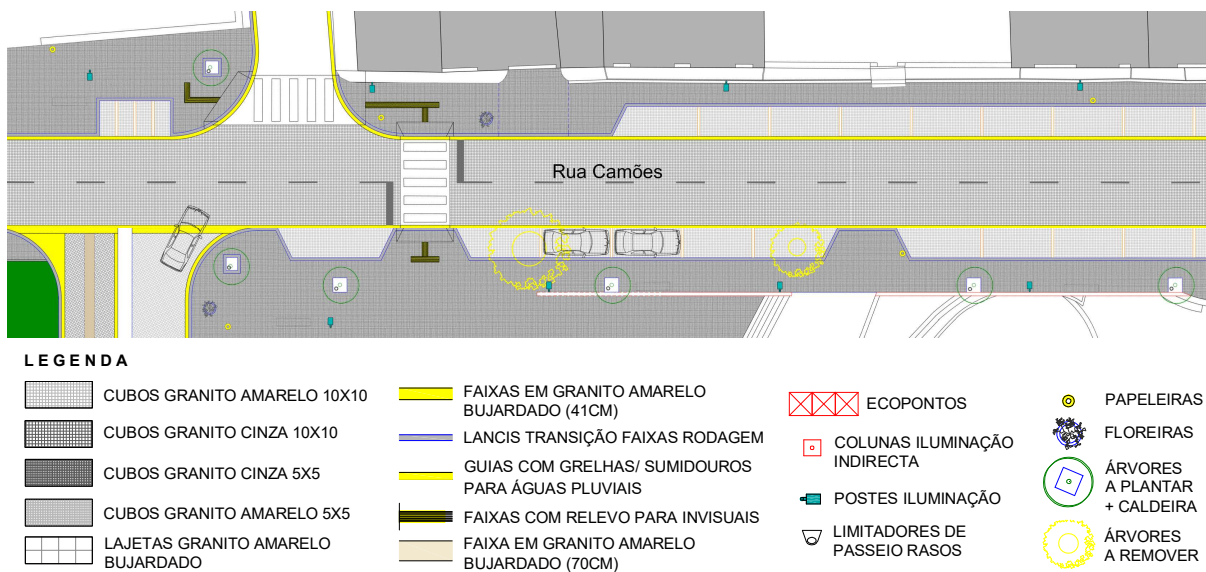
Rua de Camões – planta parcial da proposta de requalificação (s/esc.) (Projeto da requalificação do centro histórico)
